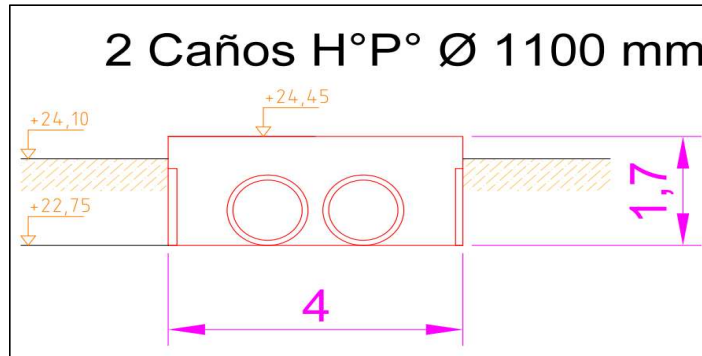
Vista Alcantarilla 2 Caños 1100 mm.
